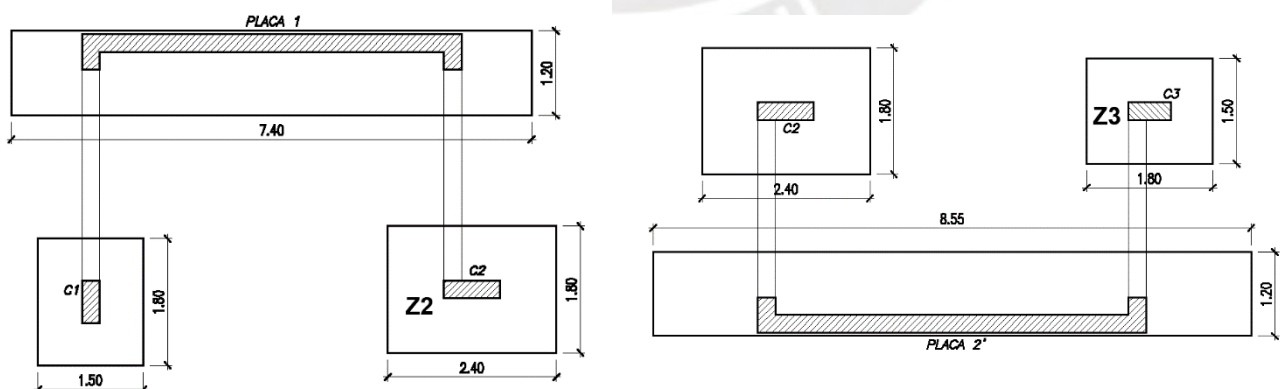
Configuración de la conexión de la zapata Z-2 (izq.) y de la zapata Z-3 (der.).
